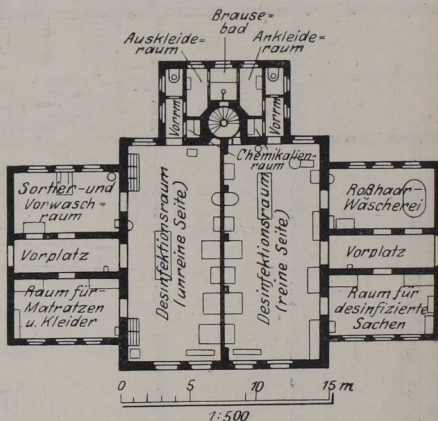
München-Schwabing, städt. Krankenhaus für 1300 Betten, Entkeimungsanstalt.
